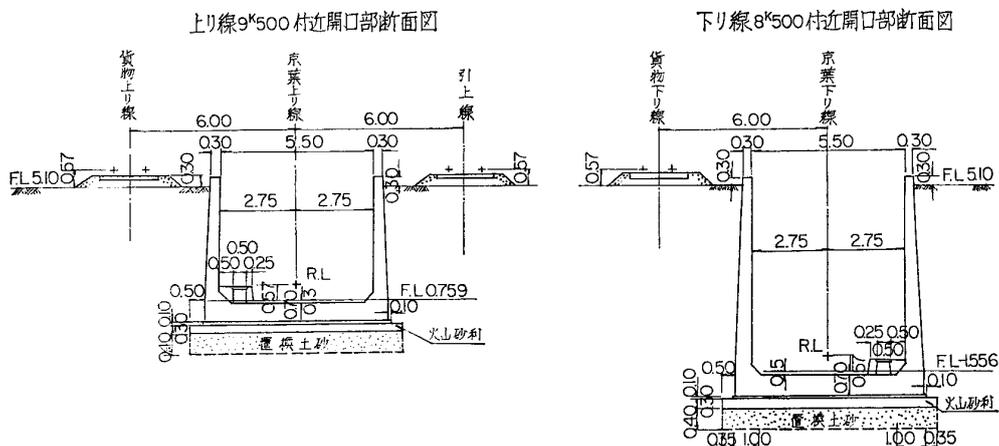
U 型土留鉄筋コンクリート断面
